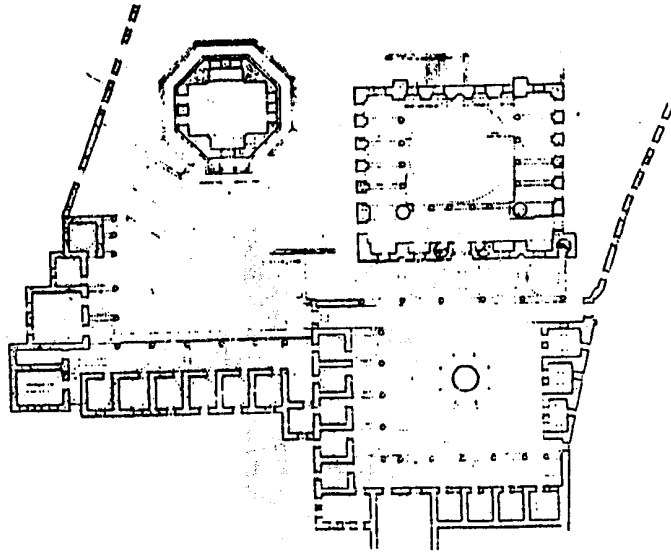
مسقط أفقي لجامع حسن بك في حاييرابولو
